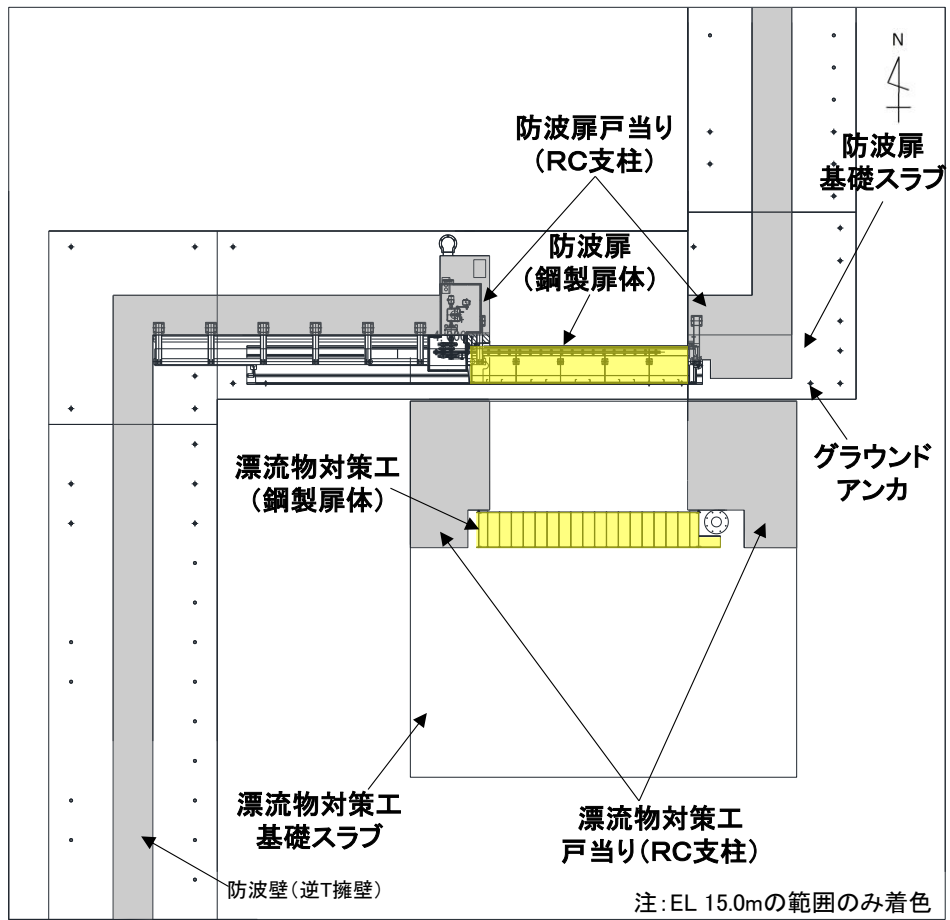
(2) 防波扉 (3号機東側) の構造概要図 (平面図)
